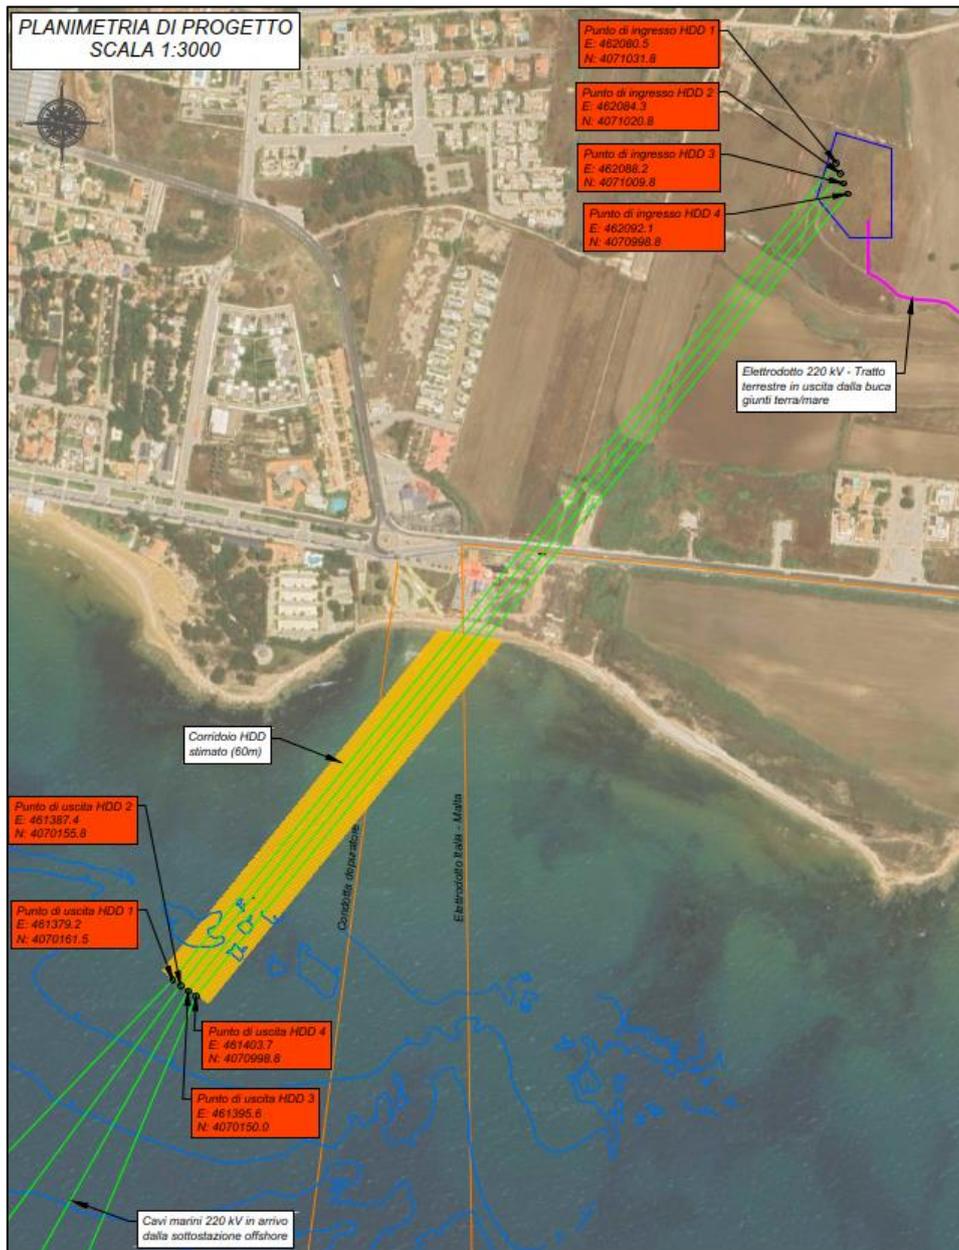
Planimetria percorso HDD terra-mare (Horizontal directional Drilling)
